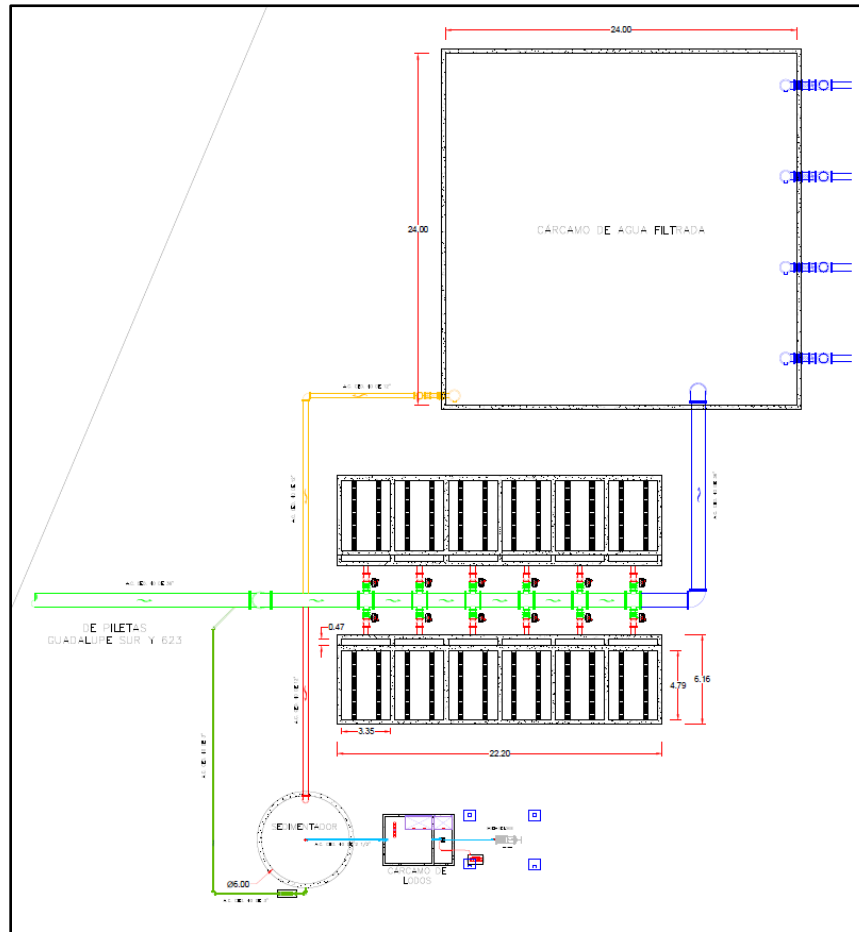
Vista de planta de los filtros a gravedad.
